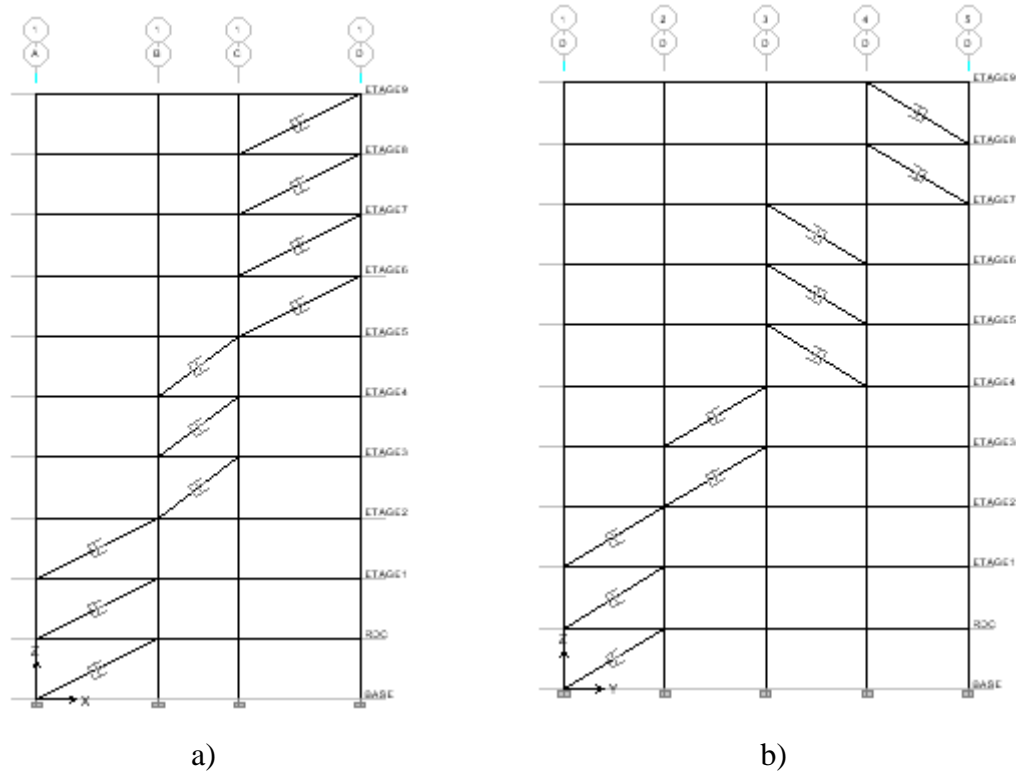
Coupes du deuxième proposition de la structure : a) Coupes A-A et A'-A' b) Coupe B-B et B'-B'
